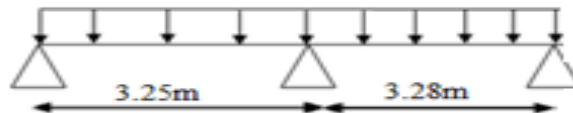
Schéma statique de la poutrelle à 2 travées.
